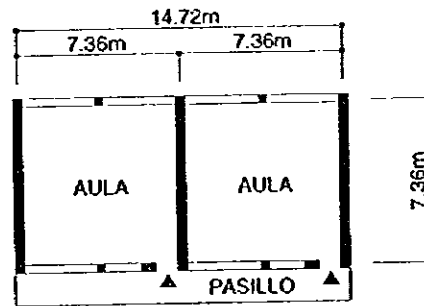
Plan superficial de edificio de tipo dos aulas
